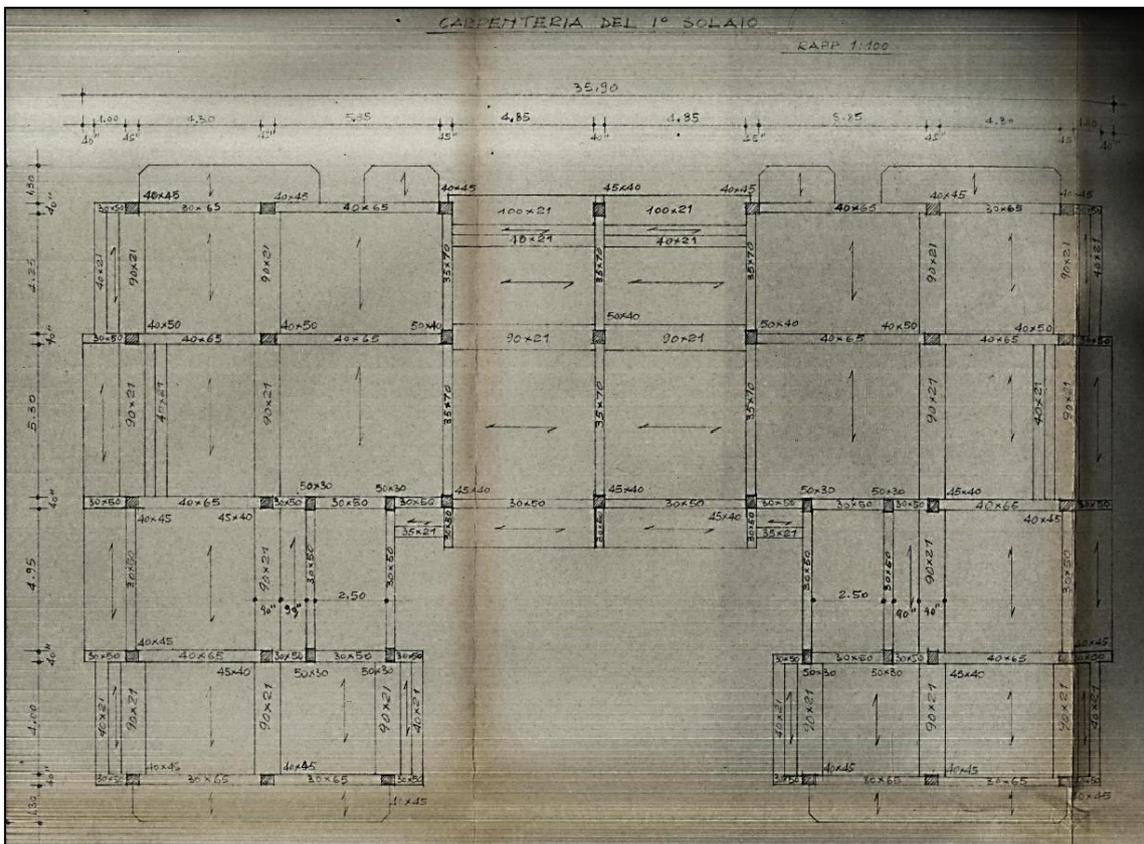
Pianta carpenteria di piano (1° solaio) reperita dall'archivio del Genio Civile
